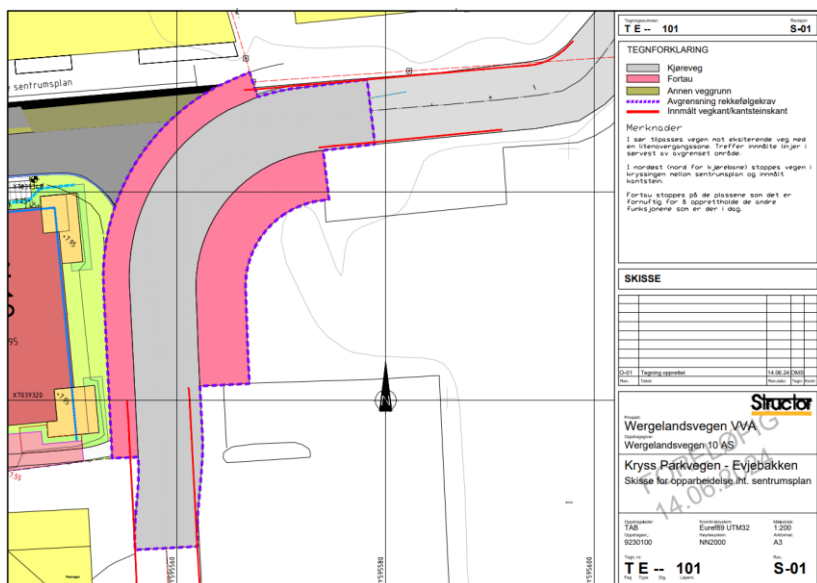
viser utsnitt fra dette krysset fra plankartet til sentrumsplanen.
